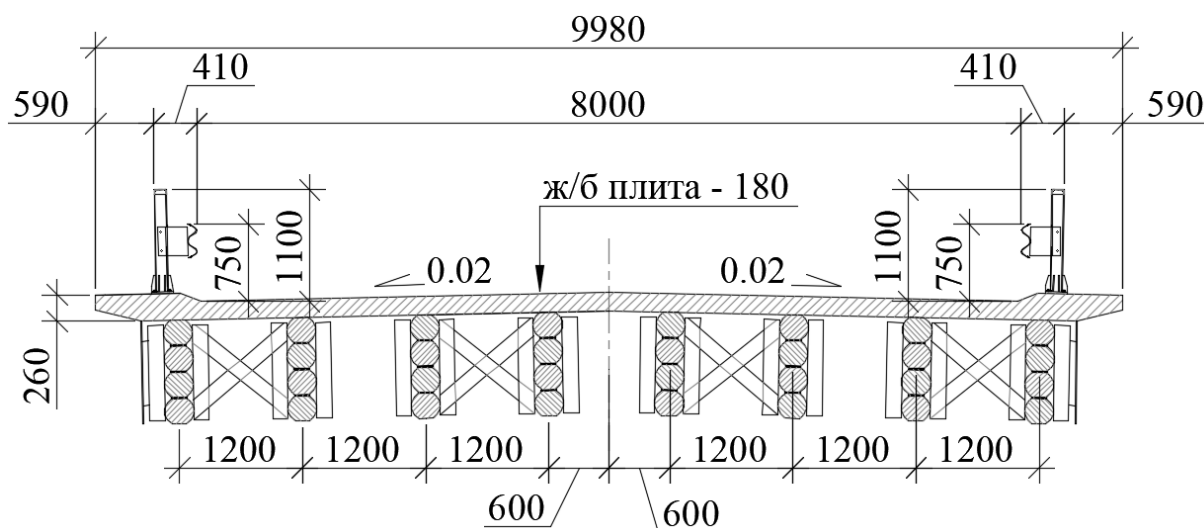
Поперечное сечение пролетного строения моста через р. Нягов длиной 15 м с составными прогонами из бревен и монолитной железобетонной плитой
